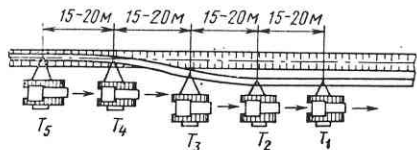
Схема укладки трубопровода способом последовательного продвижения
